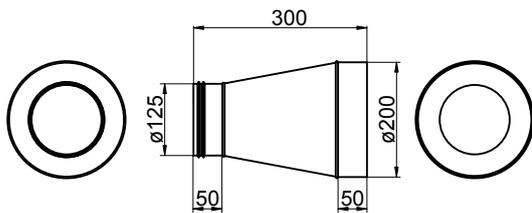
Dimensions de raccord de transition DN125 (dimensions en mm)
